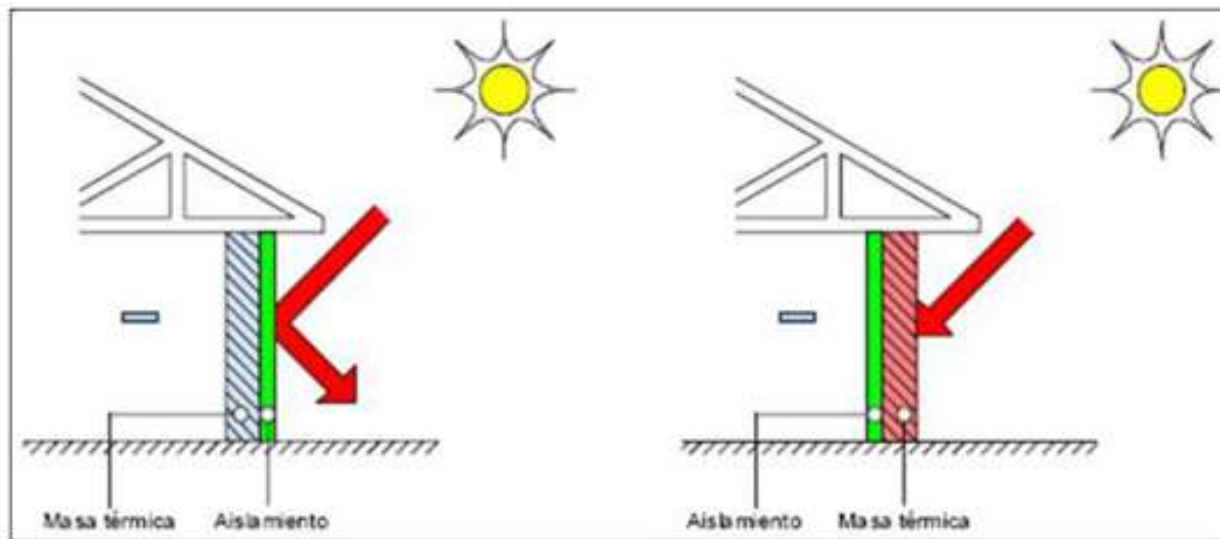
aislamiento exterior y aislamiento interior. Fuente: Barrera Oswald, *Introducción a una arquitectura bioclimática*, pág. 135.
